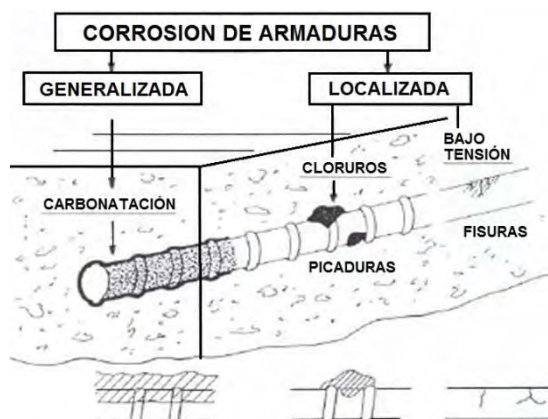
Tipos de corrosión en el concreto armado.
